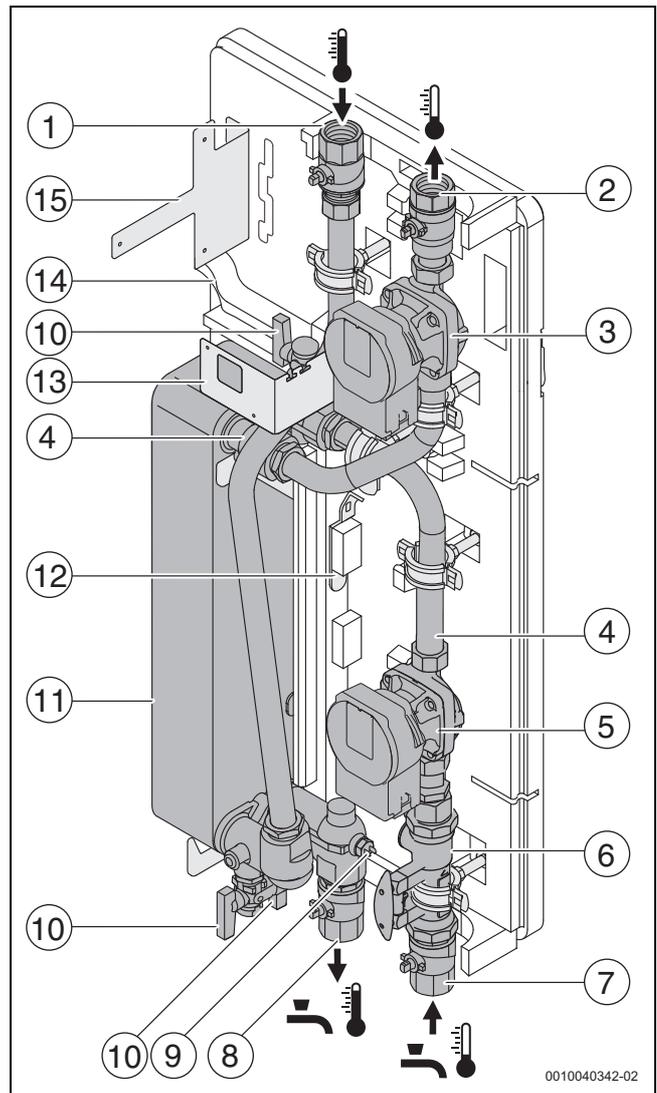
Station SLP1/3 E ohne vorderen Wärmeschutz
